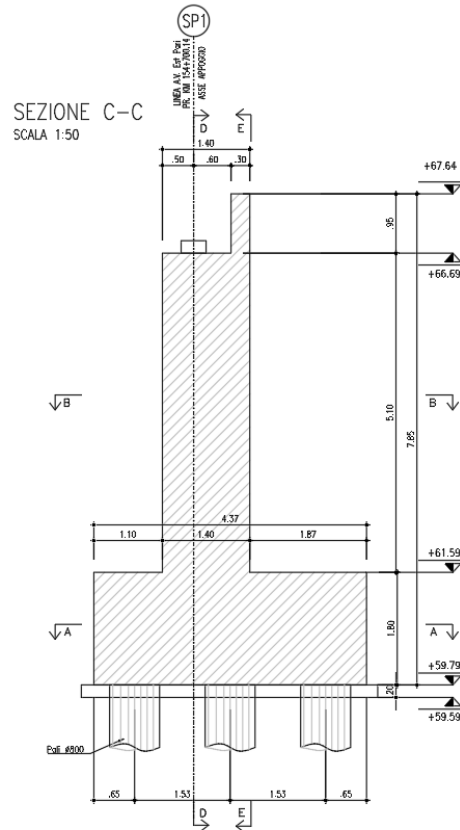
Sezione longitudinale spalla lato Milano
